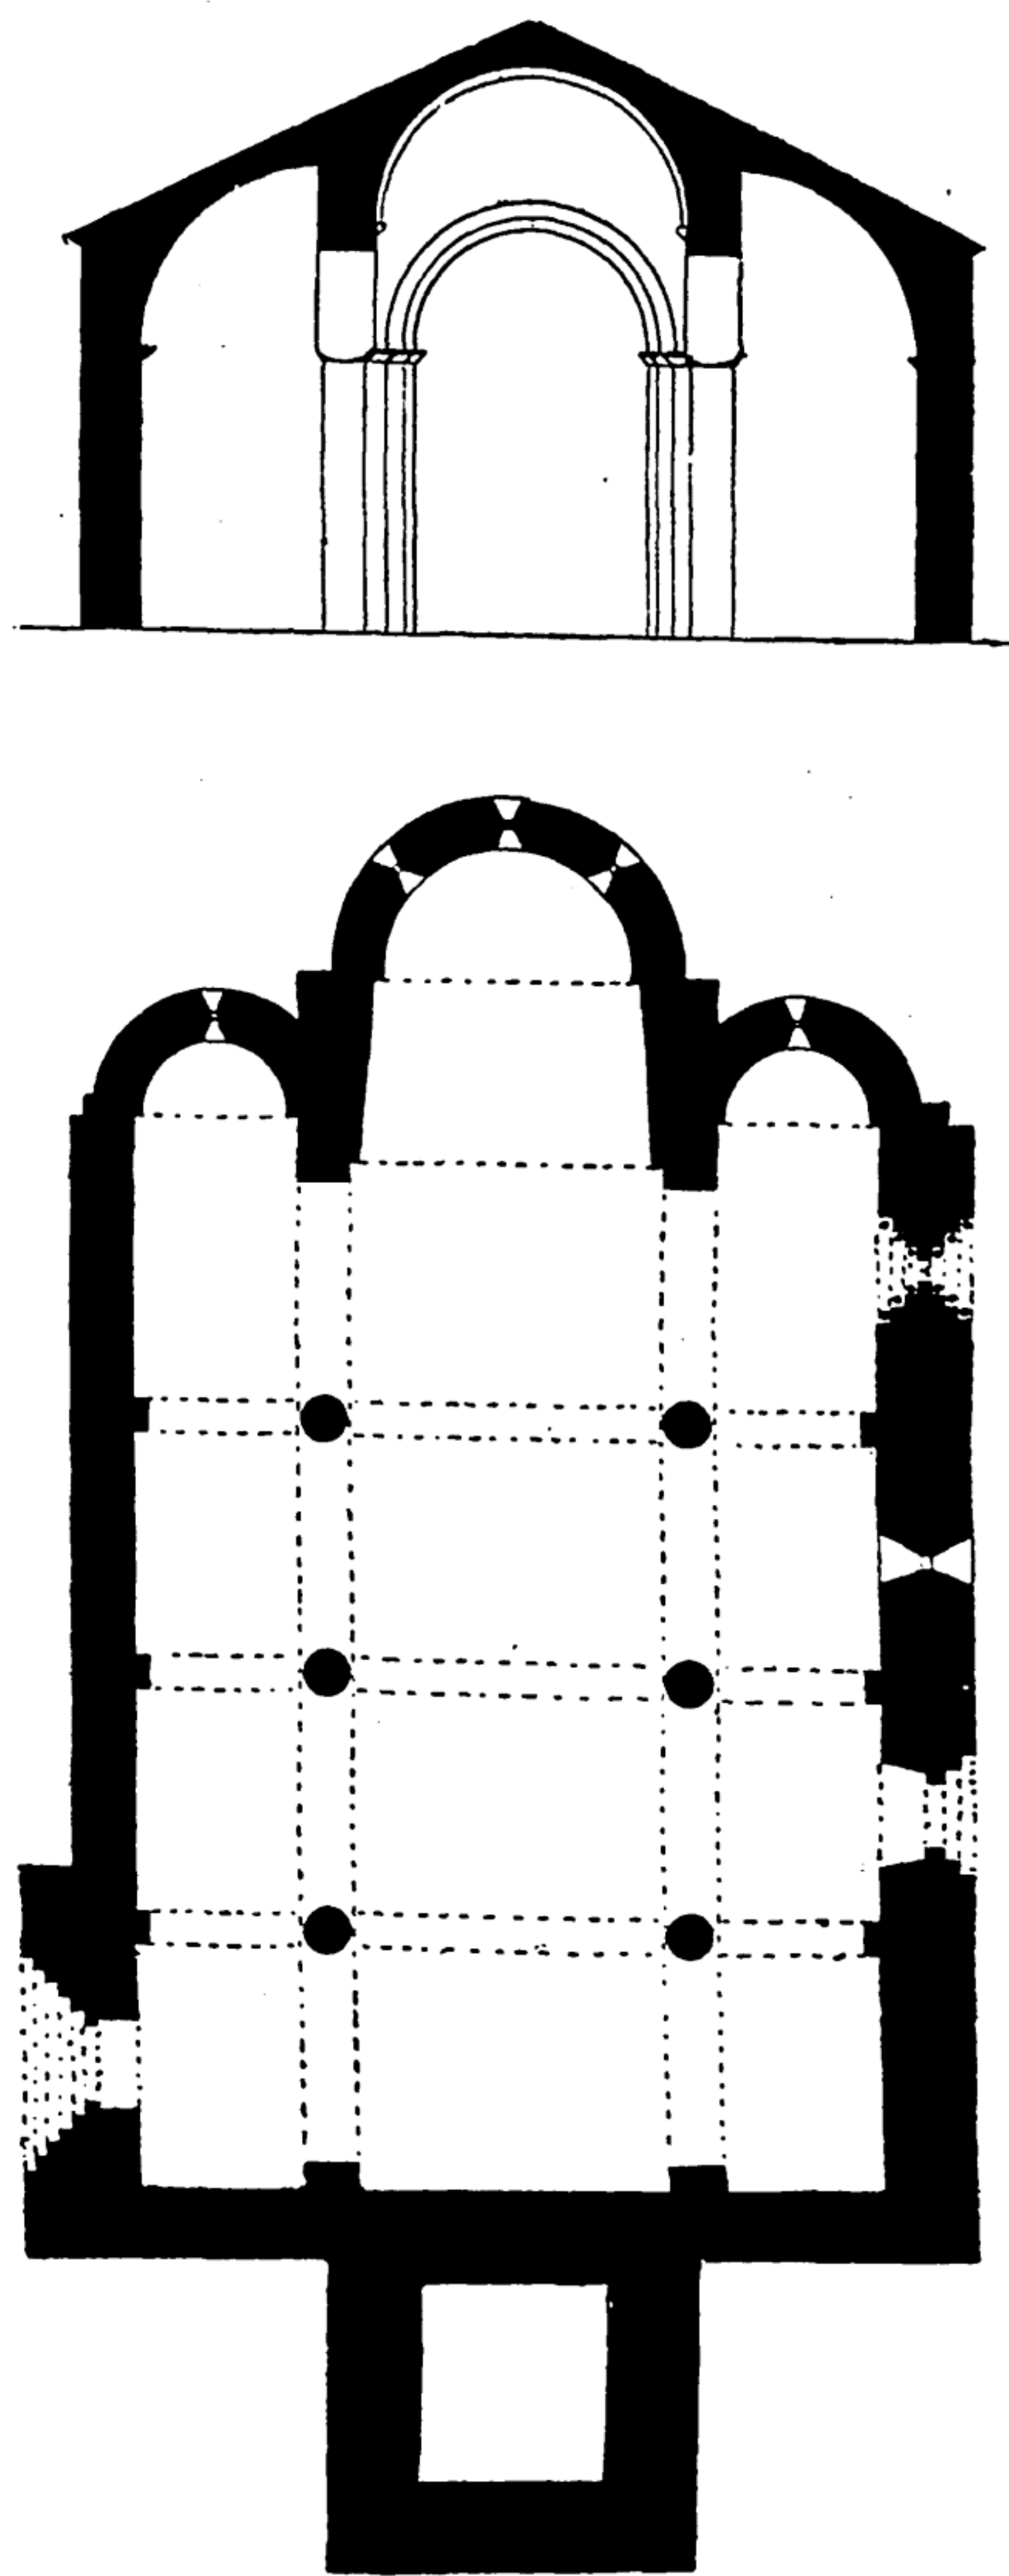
Planta y secció de l'Iglesia de Arties.
